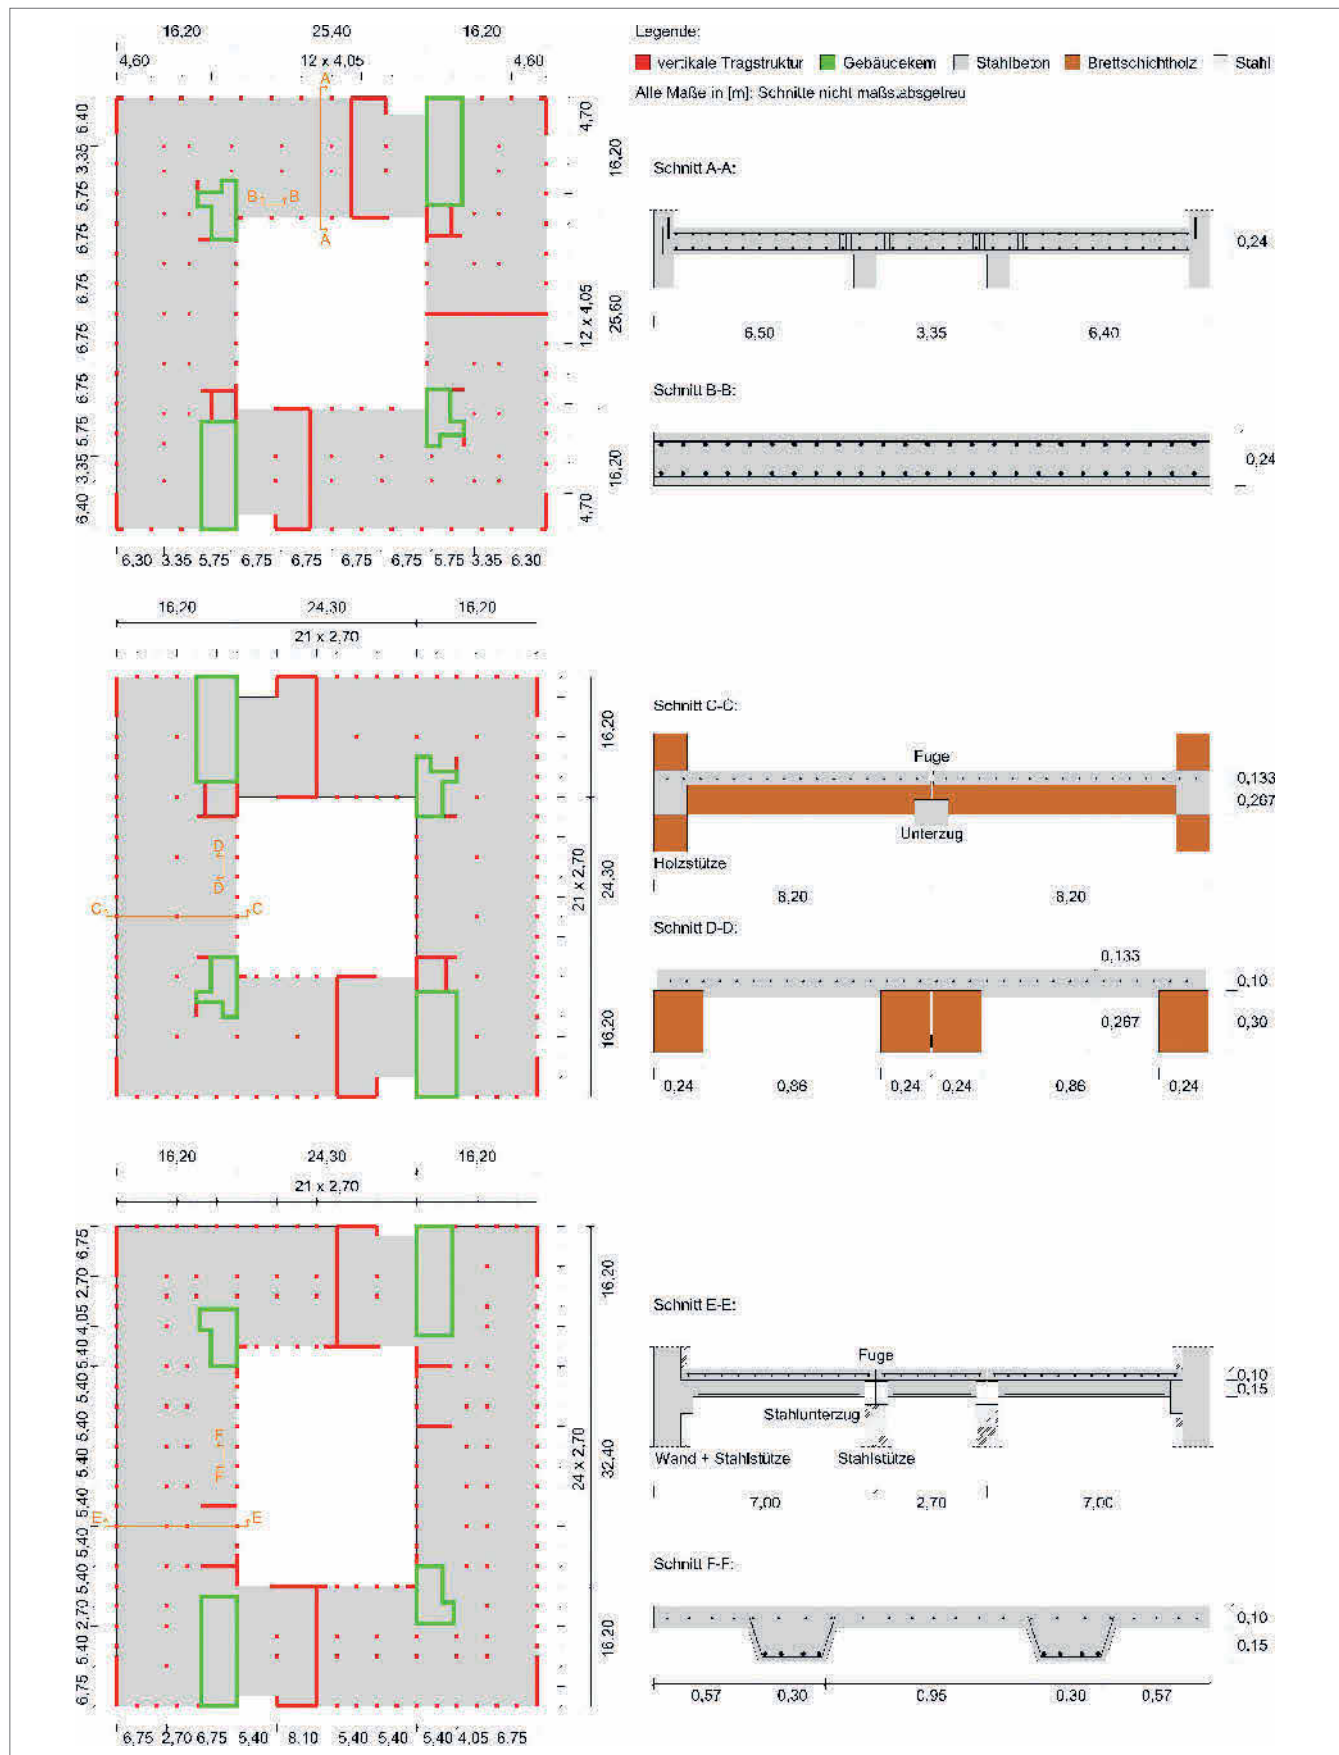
Grundrisse und Schnitte der Gebäude G1 (oben), G2 (Mitte) und G3 (unten) schematisch Grafik: RPTU
